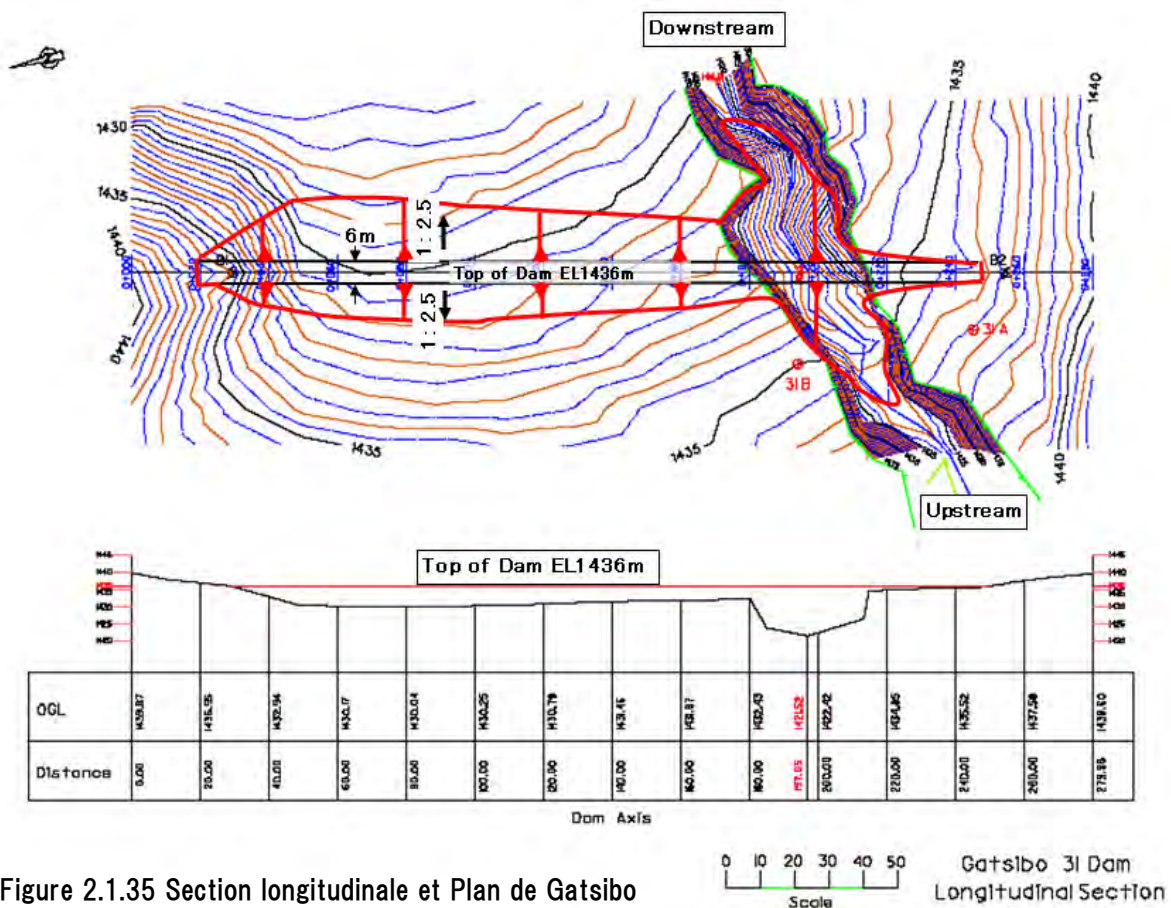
Section longitudinale et Plan de Gatsibo
